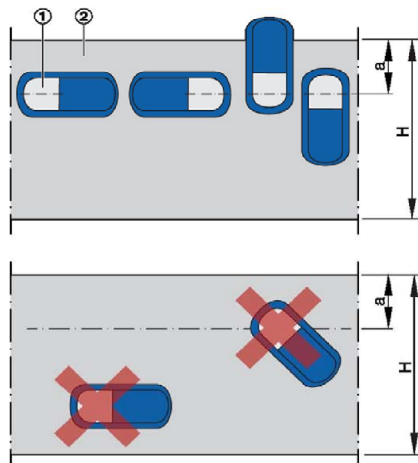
RM-O-M Einbaulagen in horizontalen Luftleitungen
